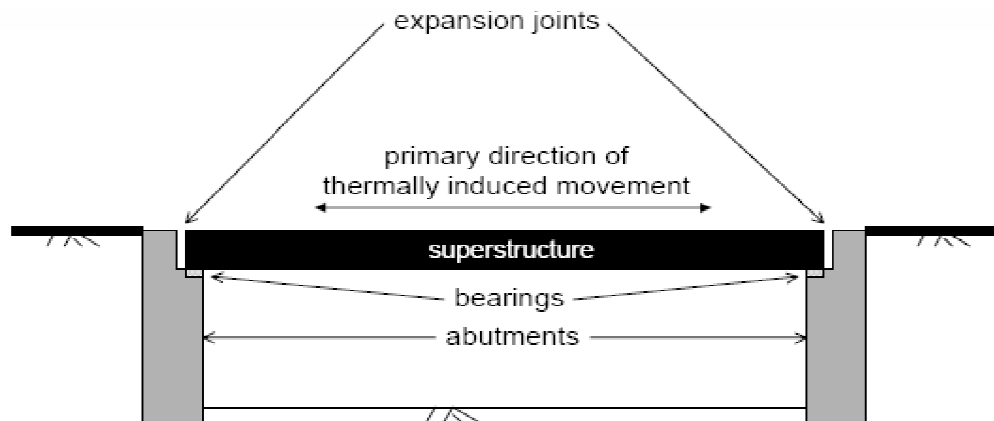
Schema strutturale di base di un ponte convenzionale (Horvath, 2000)
